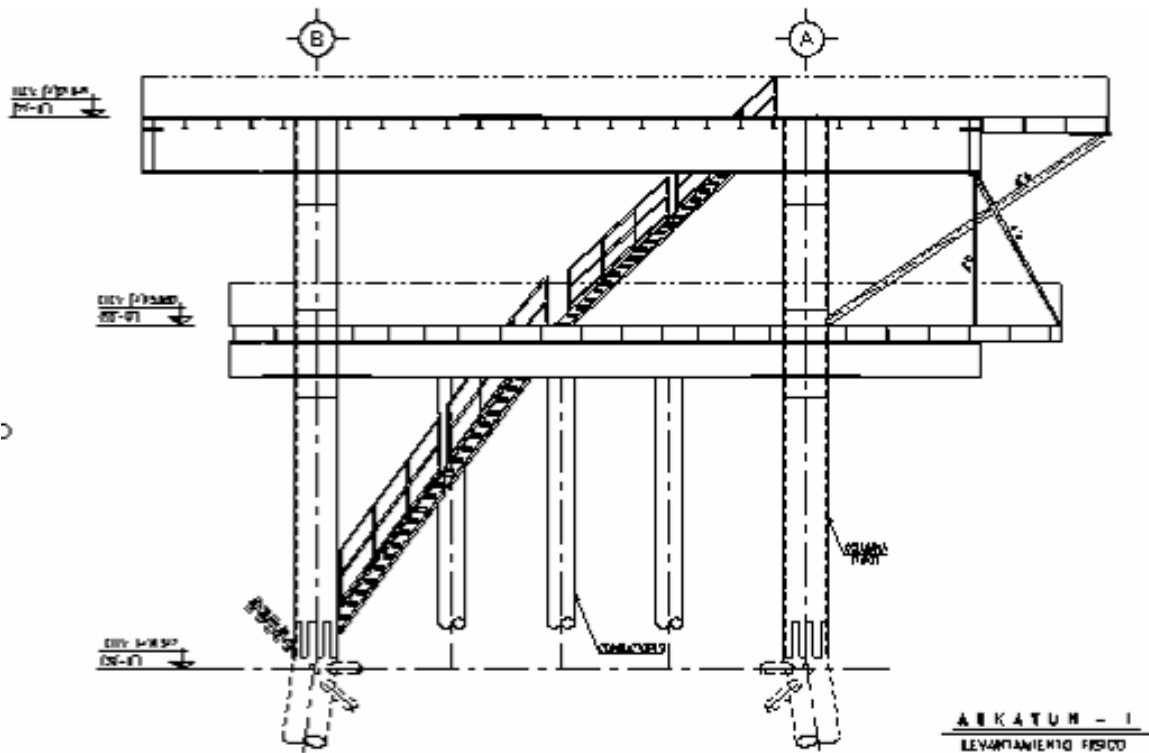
CROQUIS DE ELEVACIÓN EN EJE 1
